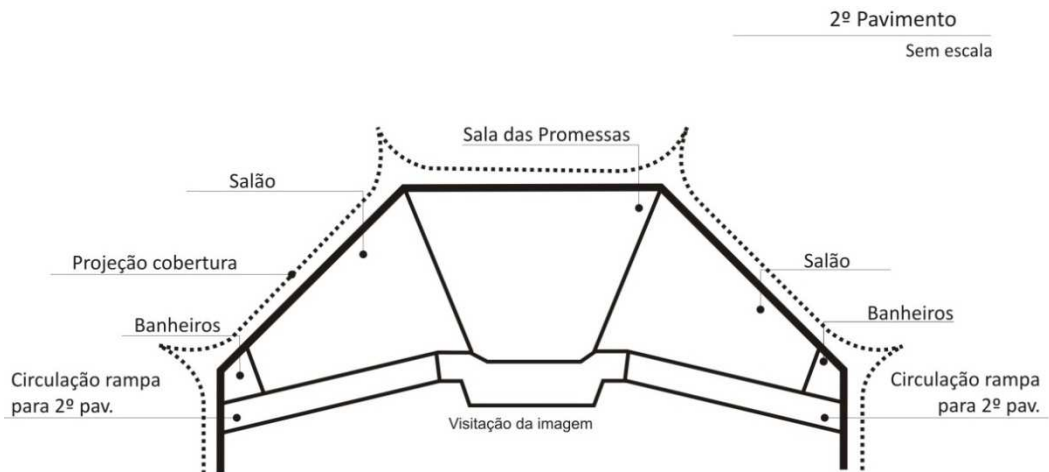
Proposta do 2º projeto - planta esquemática do novo santuário - 2º pavimento.
